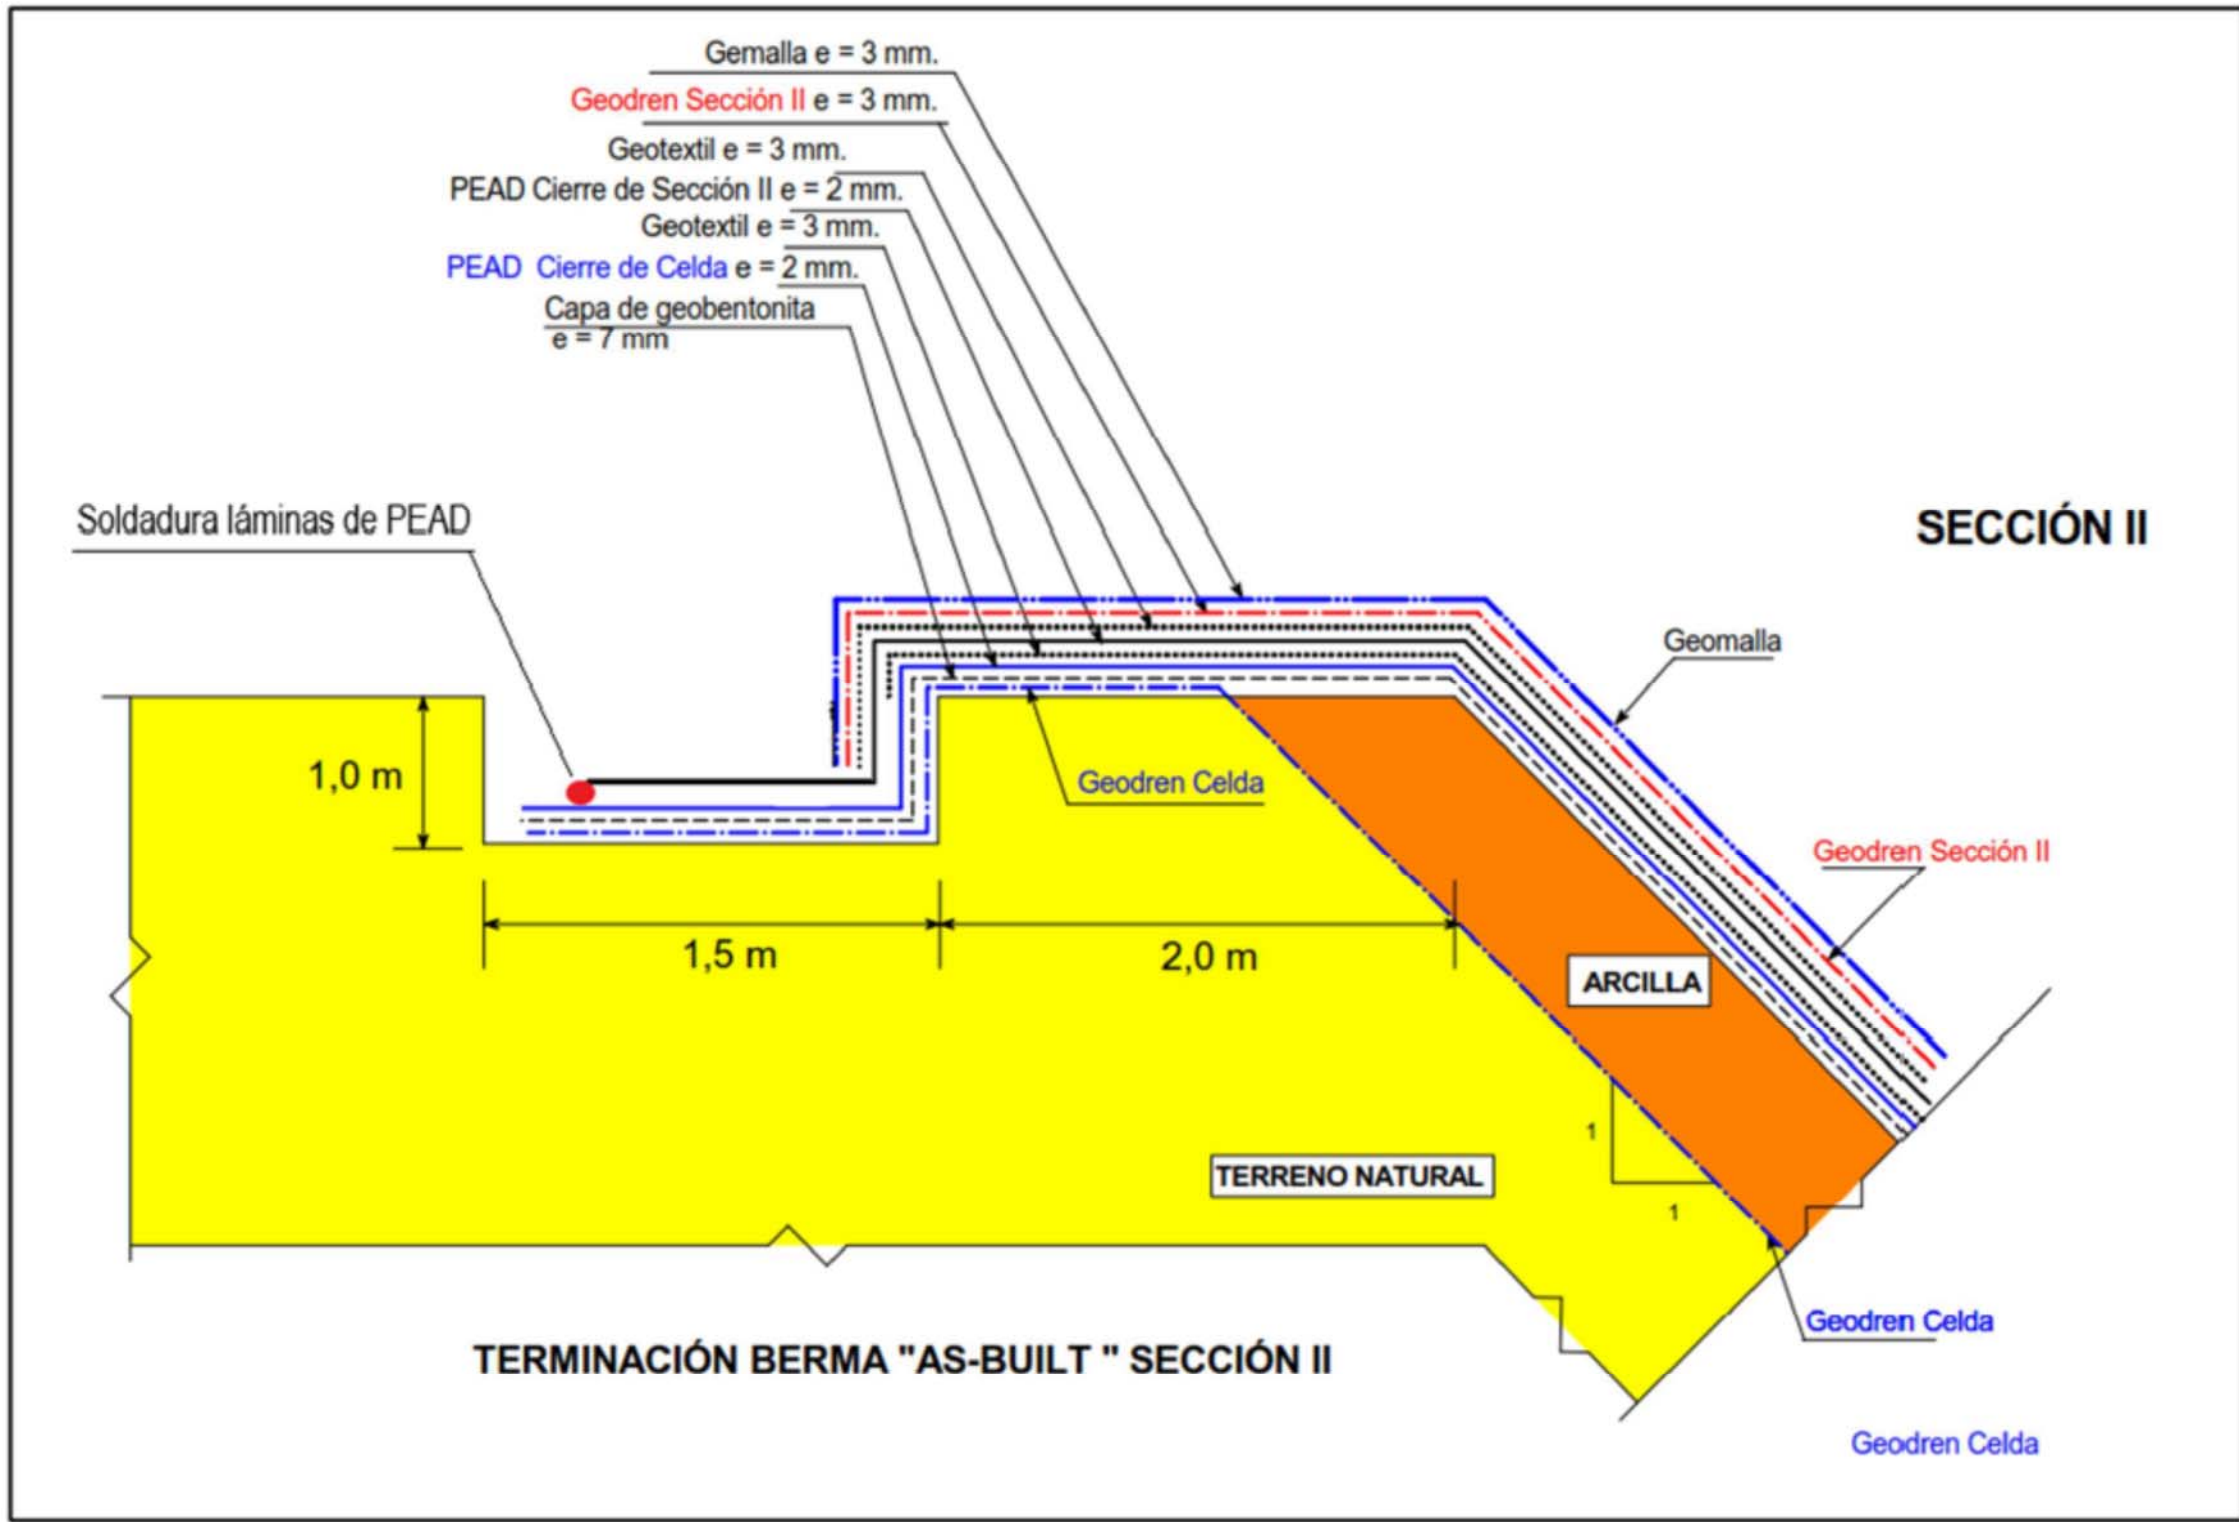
SOLDADURA LAMINAS EN ZANJA DE ANCLAJE
